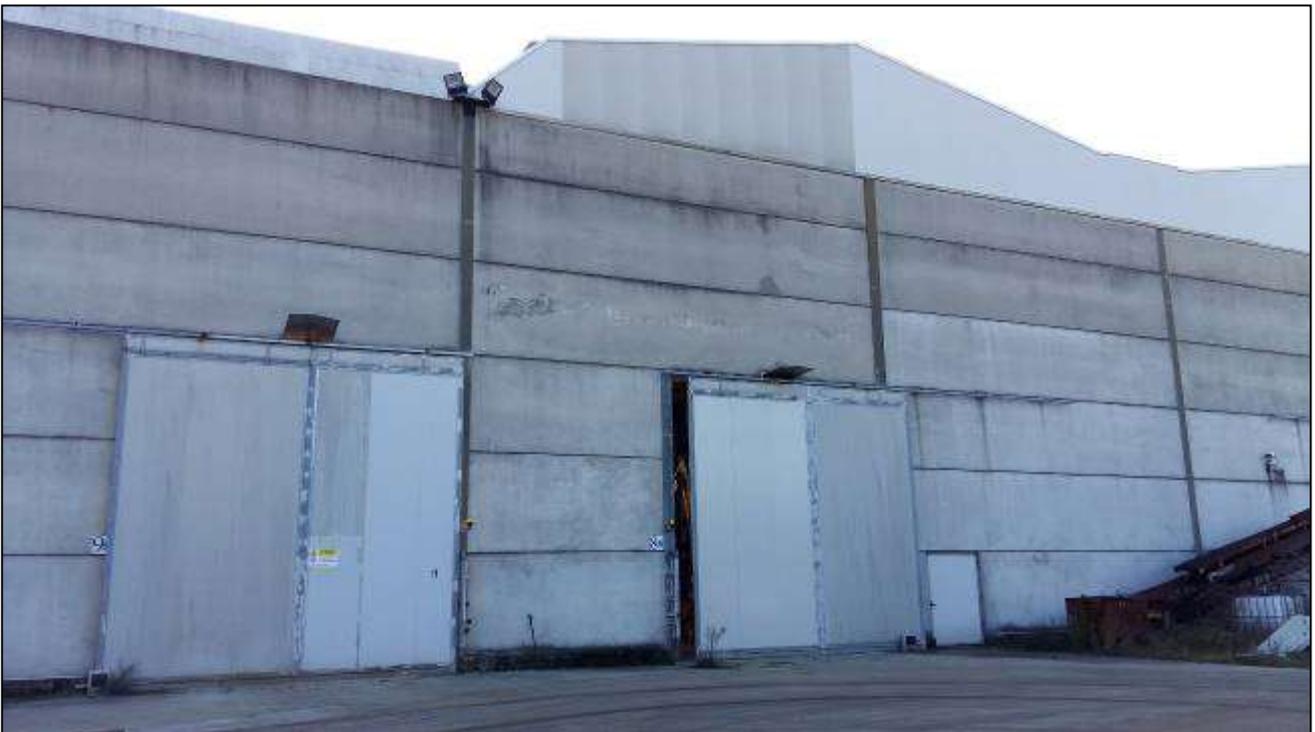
Particolare muro perimetrale stabilimento e zona deposito materie prime secondarie
